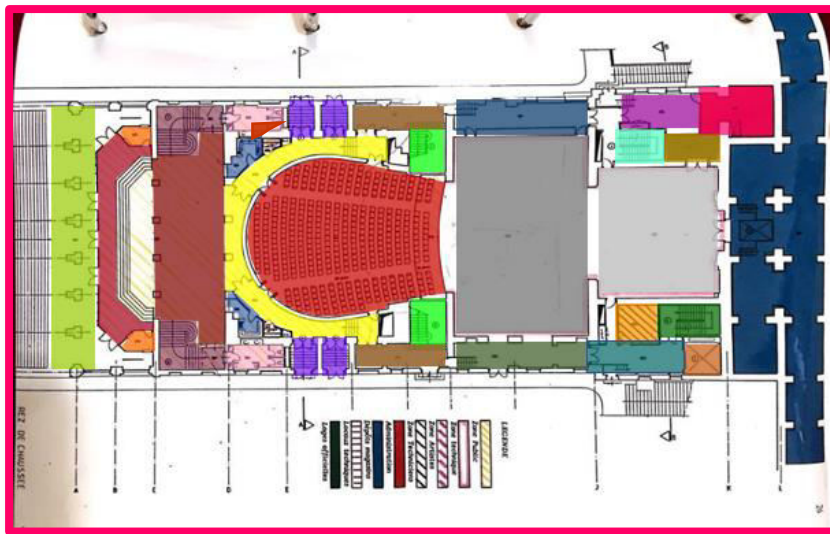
Plan de rez-de-chaussée du théâtre national algérien
